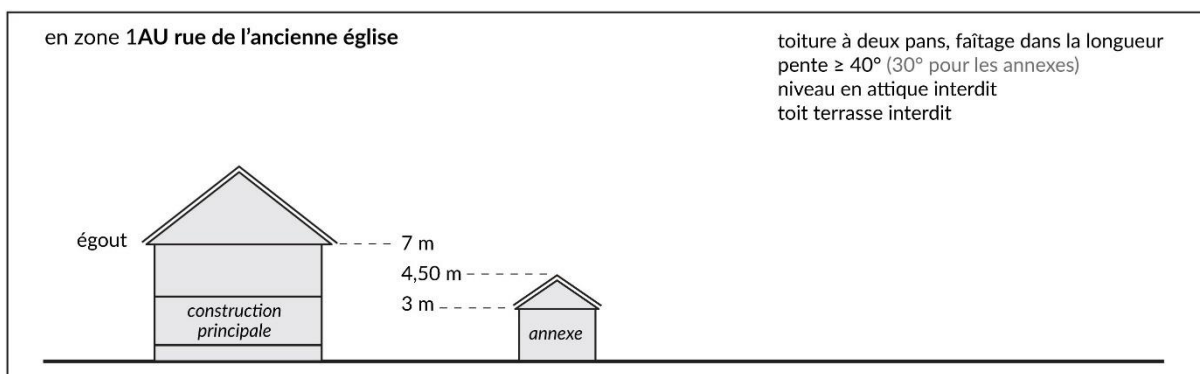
Hauteur des constructions en 1AU « Rue de l'ancienne église »
